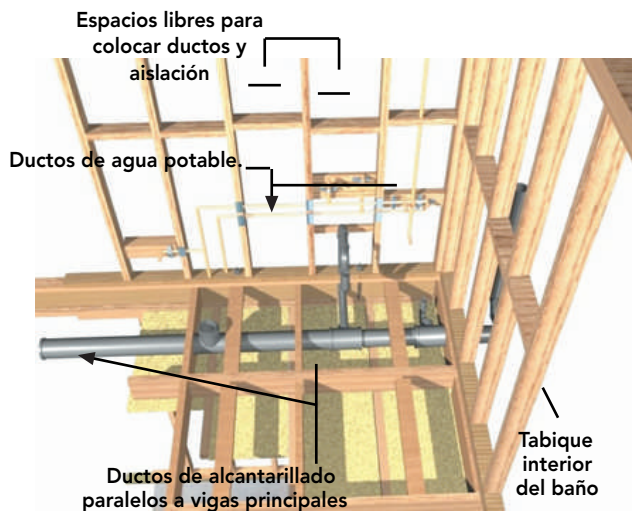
Colocación de ductos de alcantarillado y agua potable en los espacios que generan las estructuras de madera.
